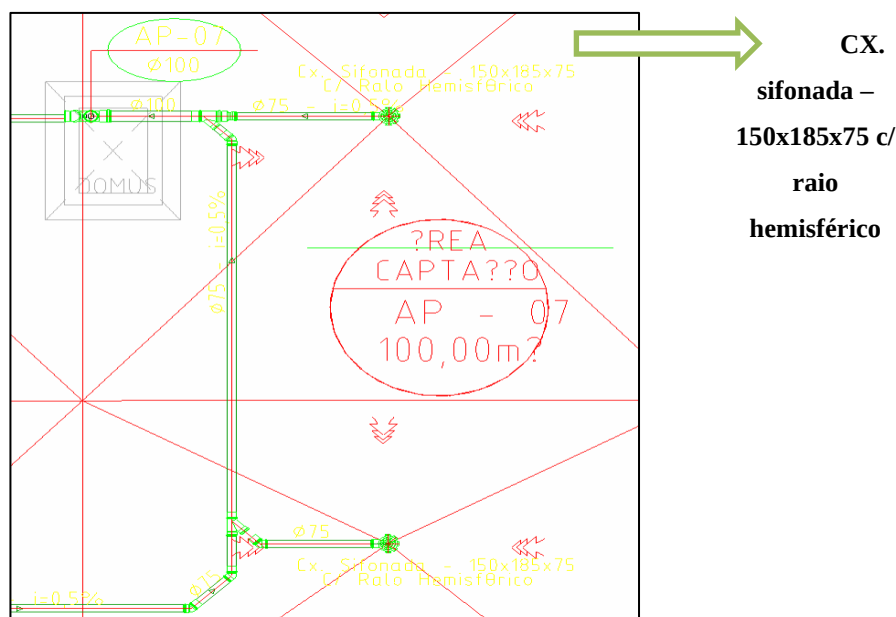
Detalhe do corte das caixas sifonadas no pavimento da cobertura
